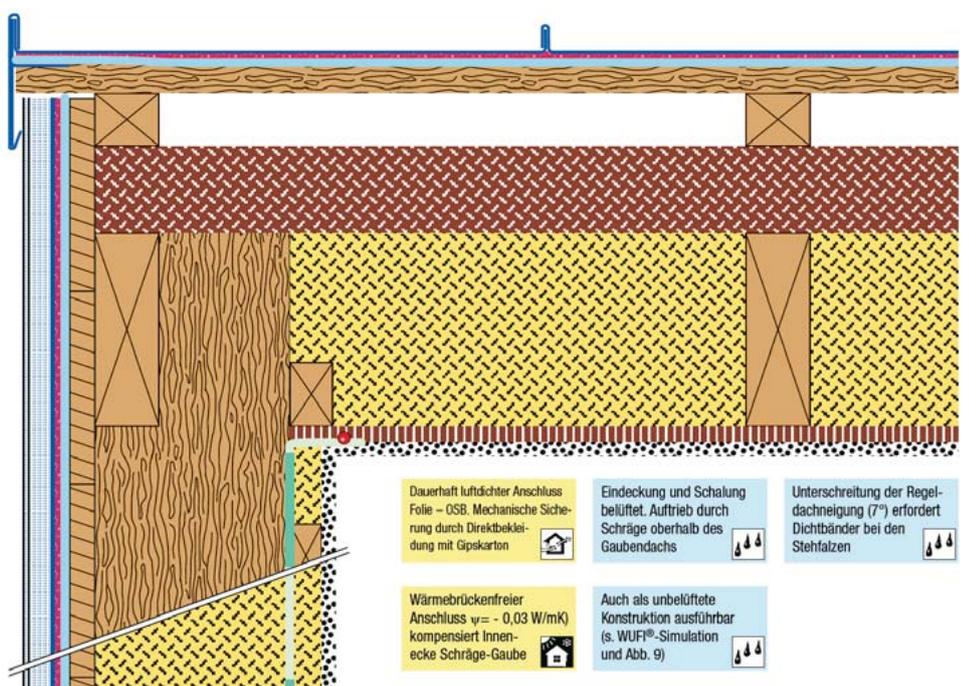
Details zur Gaube mit Blecheindeckung (Quelle: HOLZBAU - die neue quadriga, Heft 02-2014)
